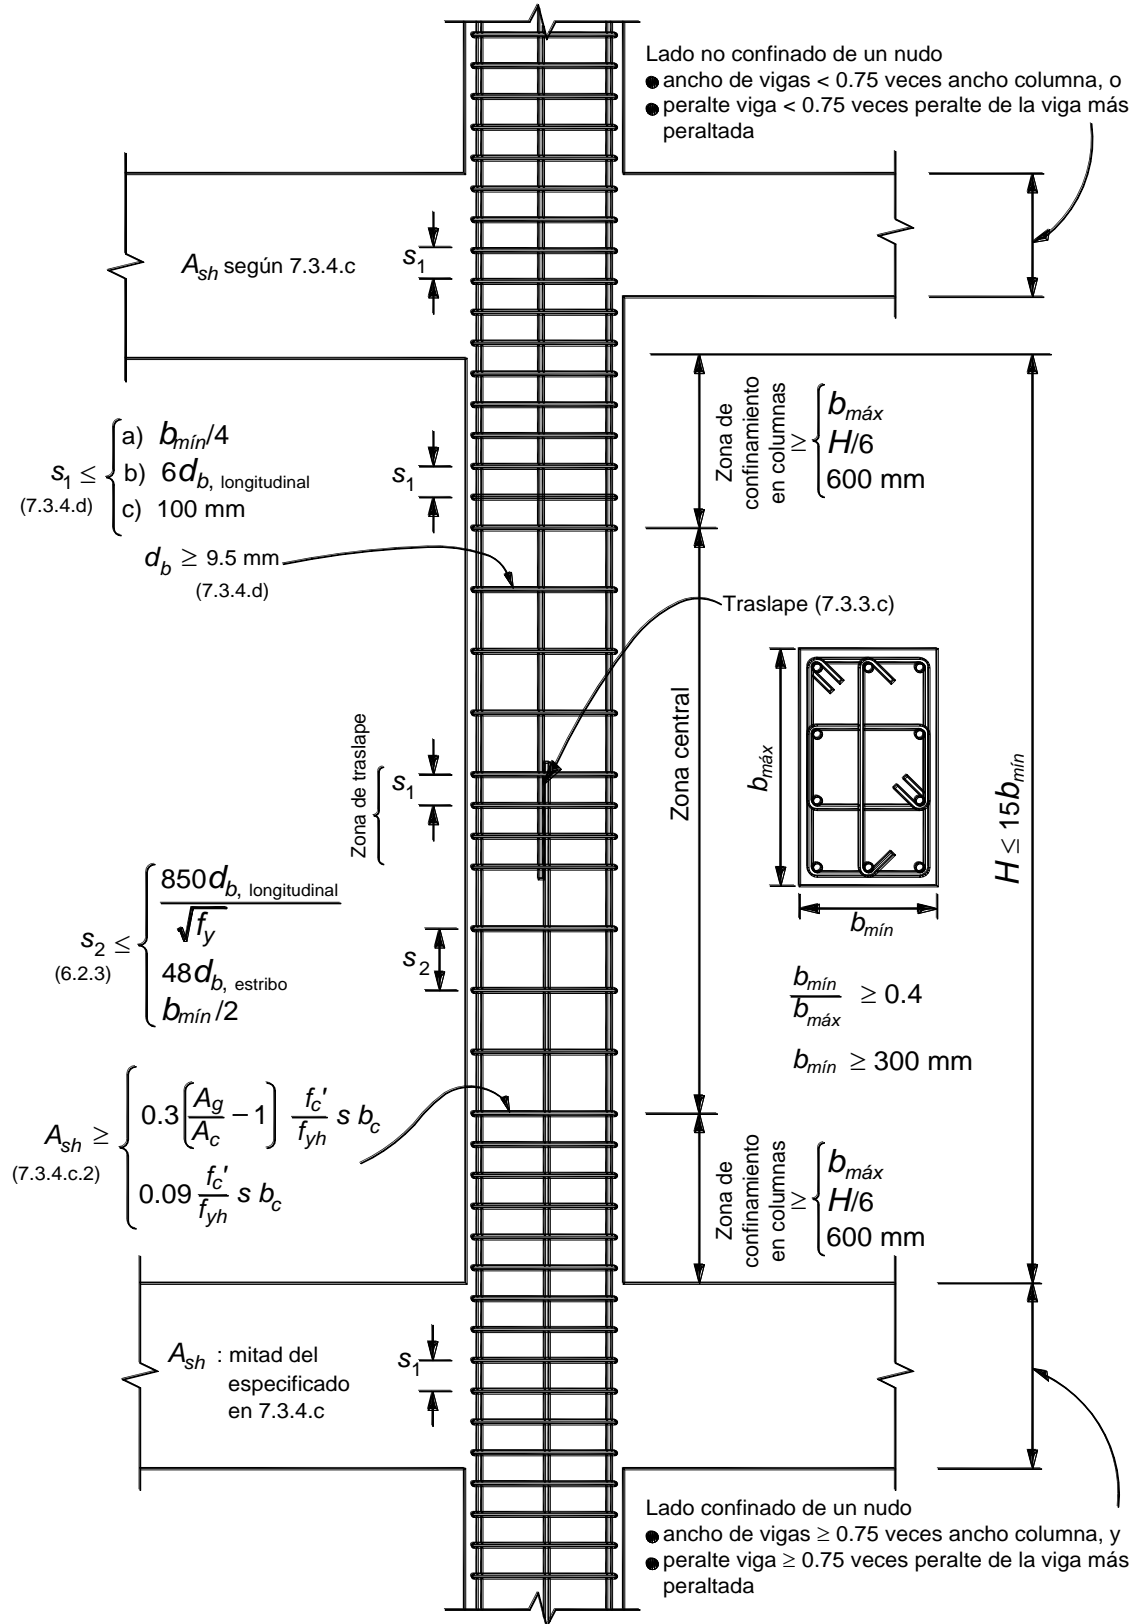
Detallado de elementos a flexocompresión de marcos dúctiles
